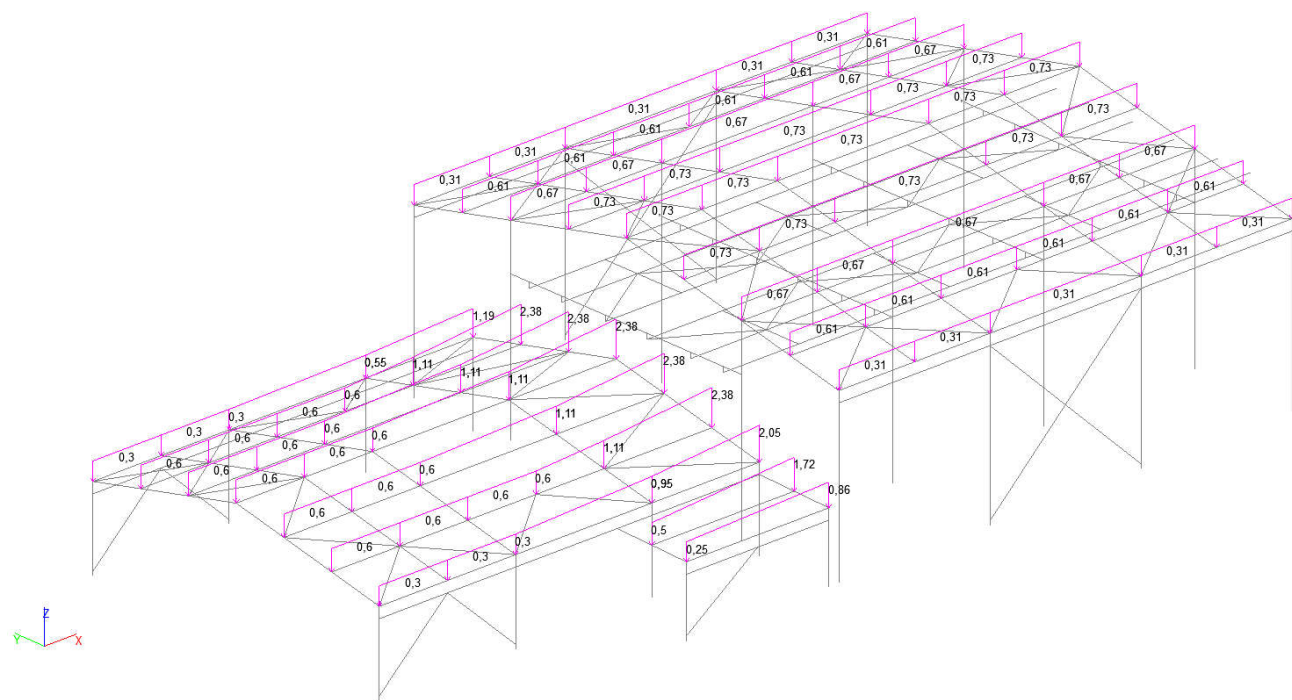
Схема приложения нагрузки L4 «Снеговая нагрузка»
